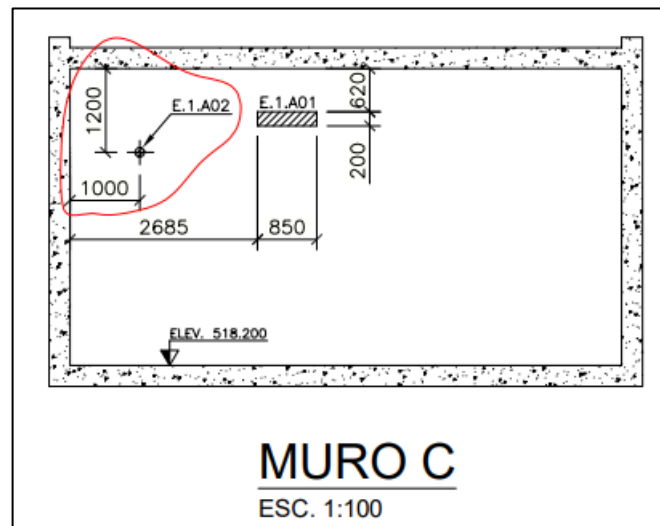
Penetración PNT-E.1.A02 en muro “C” de Sala Maquinas POT. Extraído de plano 062-IDG-DW-0610
